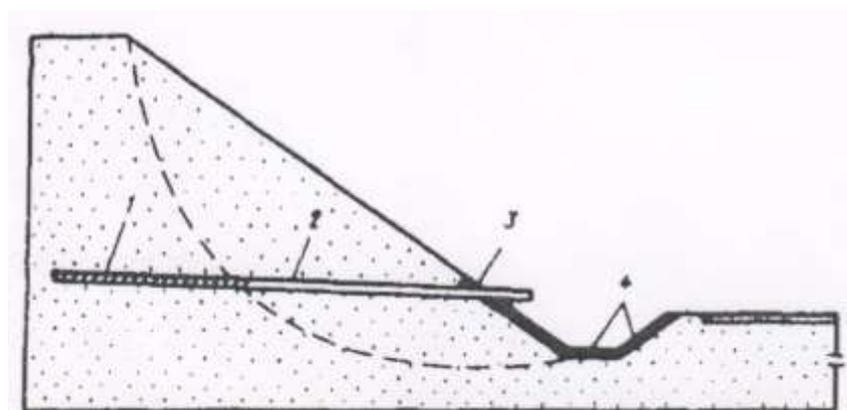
Устройство основания и укладка на него фильтровых труб
